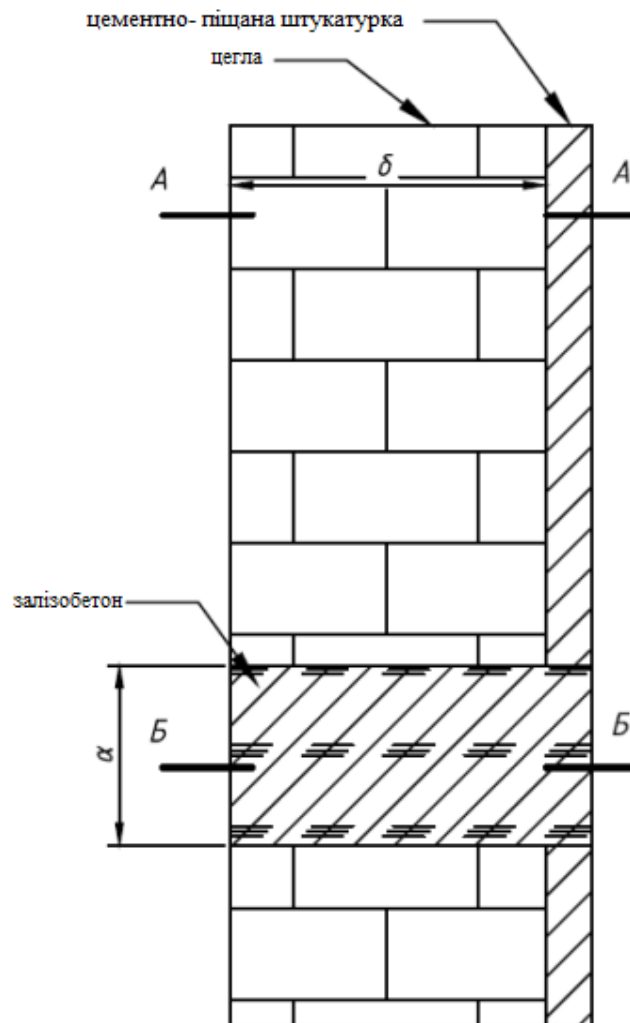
Цегляна стіна із залізобетонною колоною.
